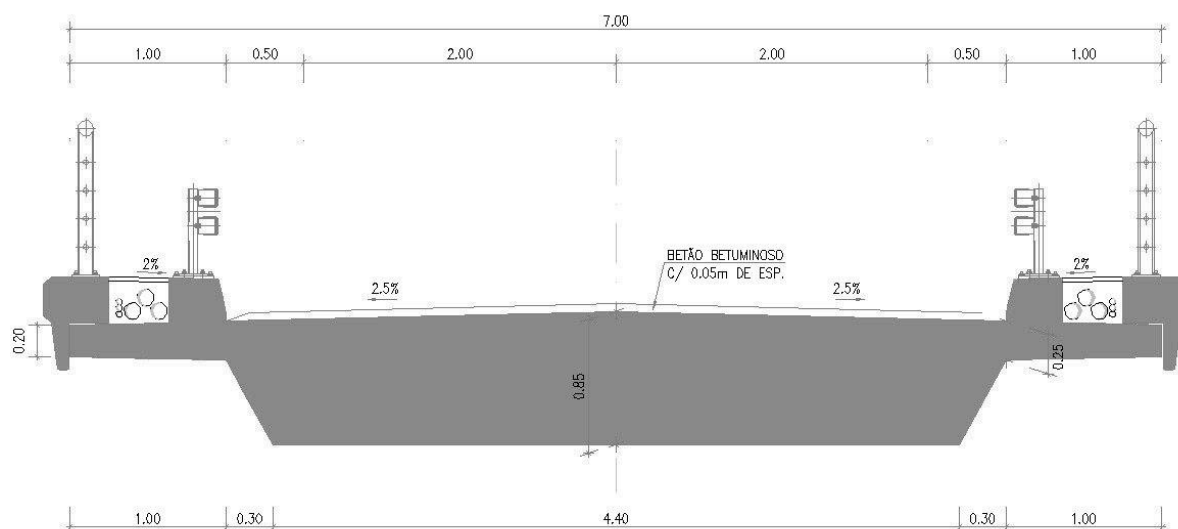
Corte transversal da passagem superior – desenho do projecto.
